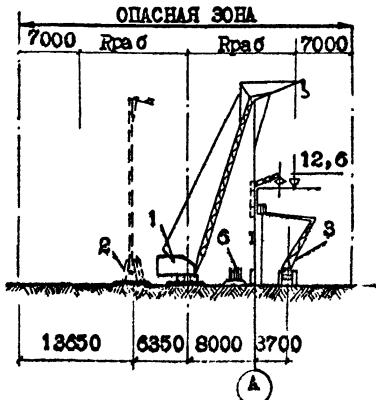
Схема монтажа стеновых панелей стреловыми кранами.
